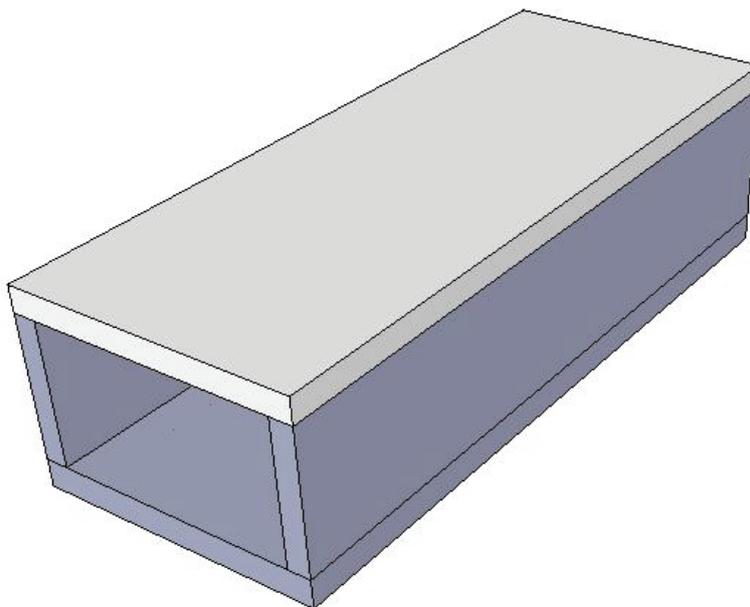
Bodenplatte mit Tunnelwand und Tunneldecke
